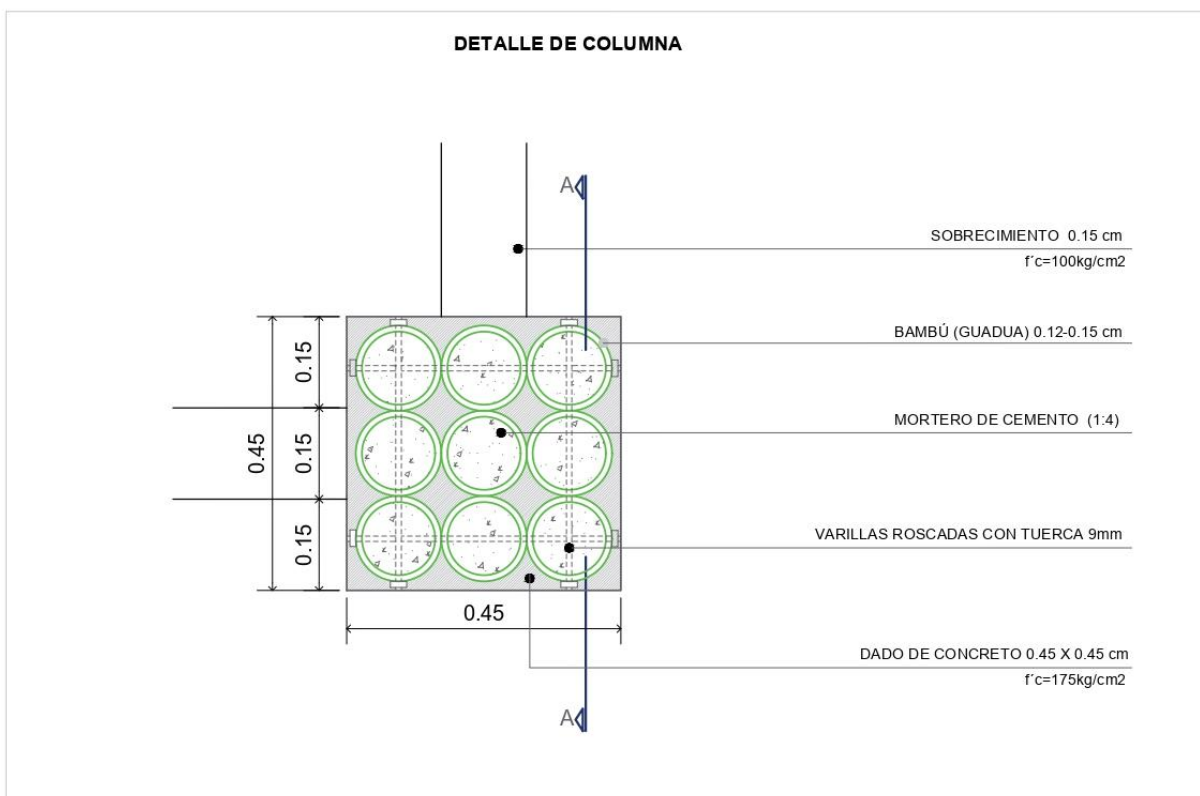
Detalle constructivo de columna, vista en planta. Fuente: El autor
